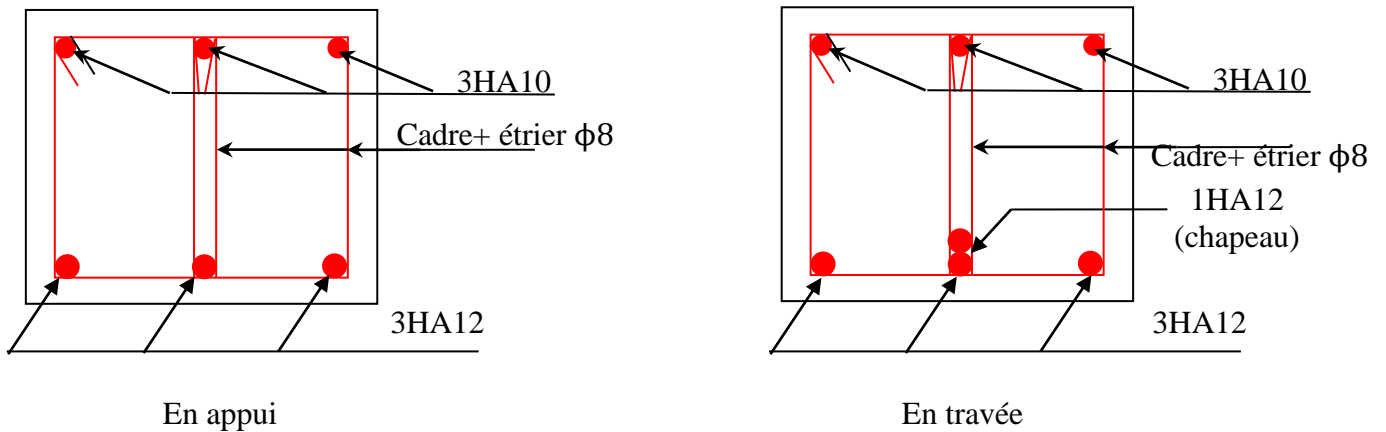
Schéma de ferrailage de la poutre de chaînage
